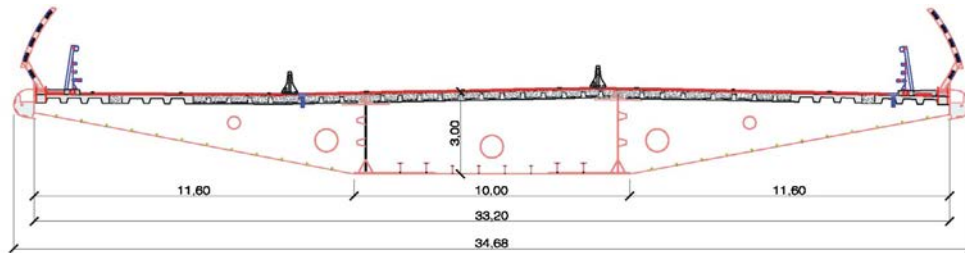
Sección transversal del viaducto de acceso al lado de Cádiz.
